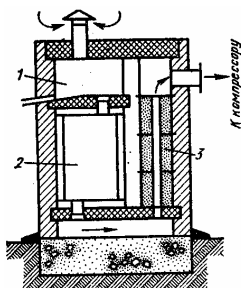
Комбинированный глушитель шума всасывания поршневой компрессорной станции
